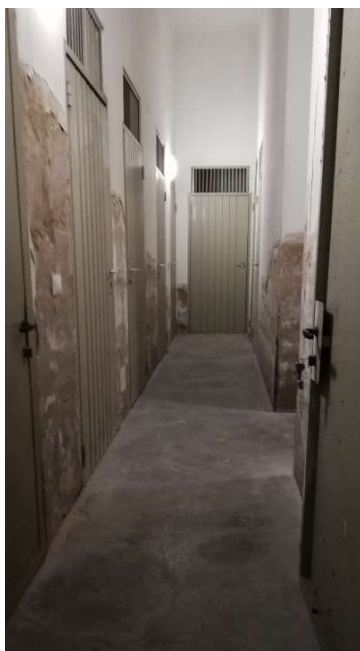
Locali tecnici a piano interrato / Foto 11 – Locale cantina
